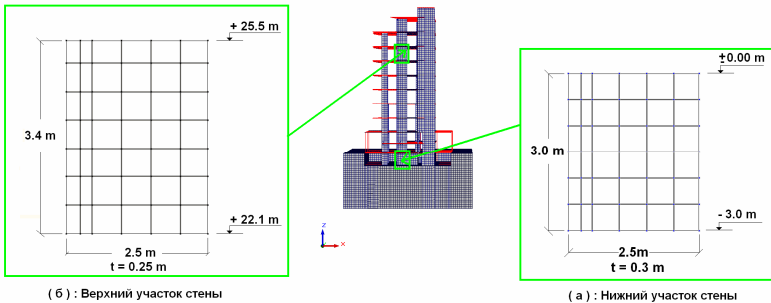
Расположение и размеры участков монолитных железобетонных стен здания – вариант (А)
